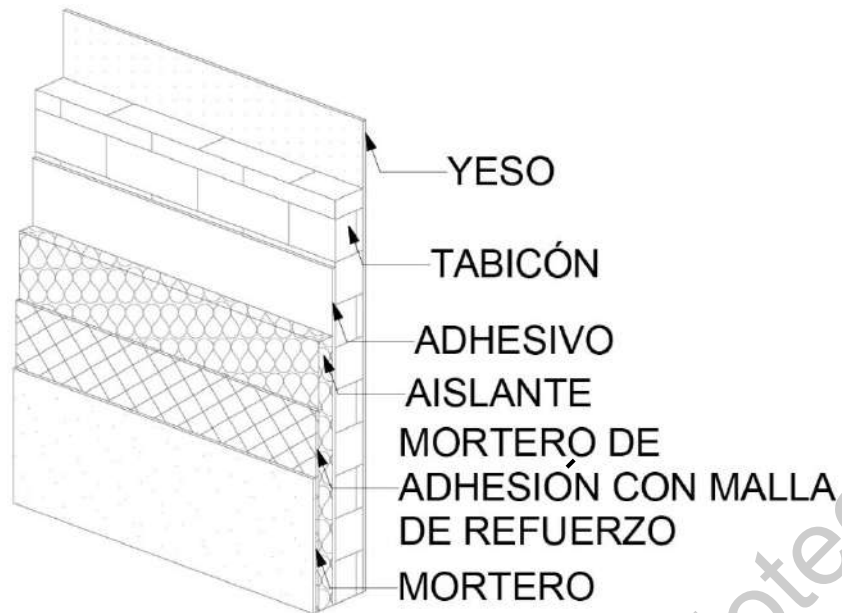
Detalle de muro con aislante térmico. Elaboración propia.
